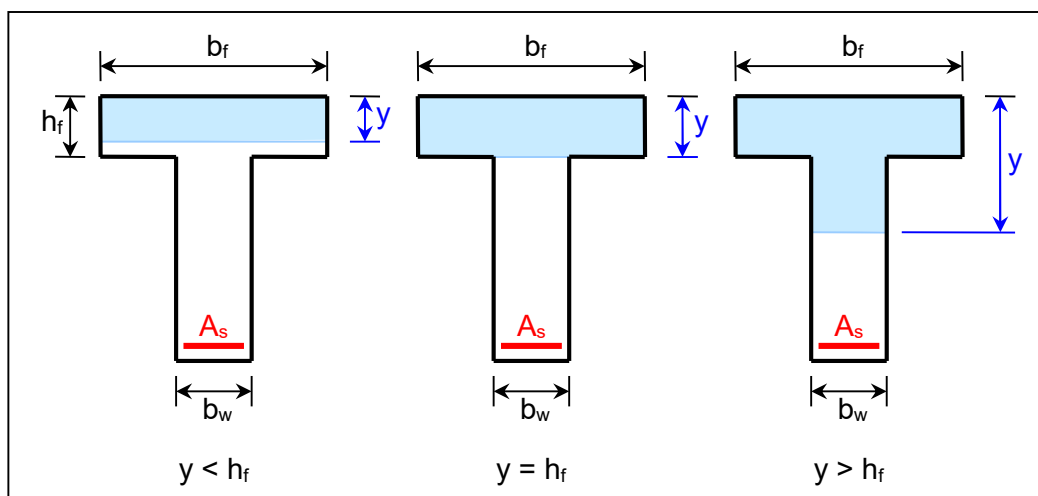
Regiões de concreto comprimido em vigas de seção T
